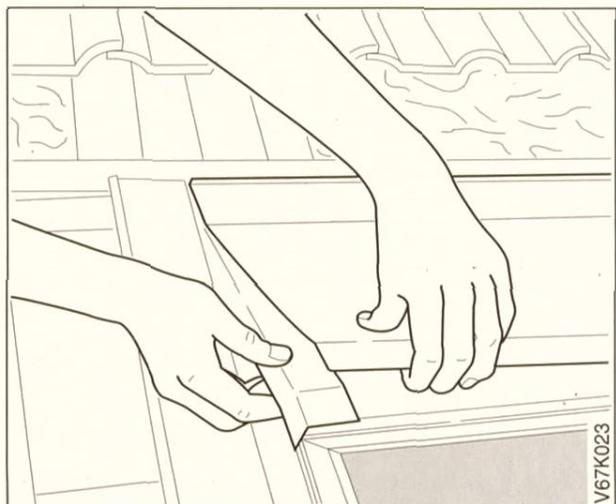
Eindeckecken oben links und rechts auflegen. Auf diese etwas Silikon auftragen. Obere Abschlussbleche auflegen und mit Blechnut in Kollektorfalz einschieben.
